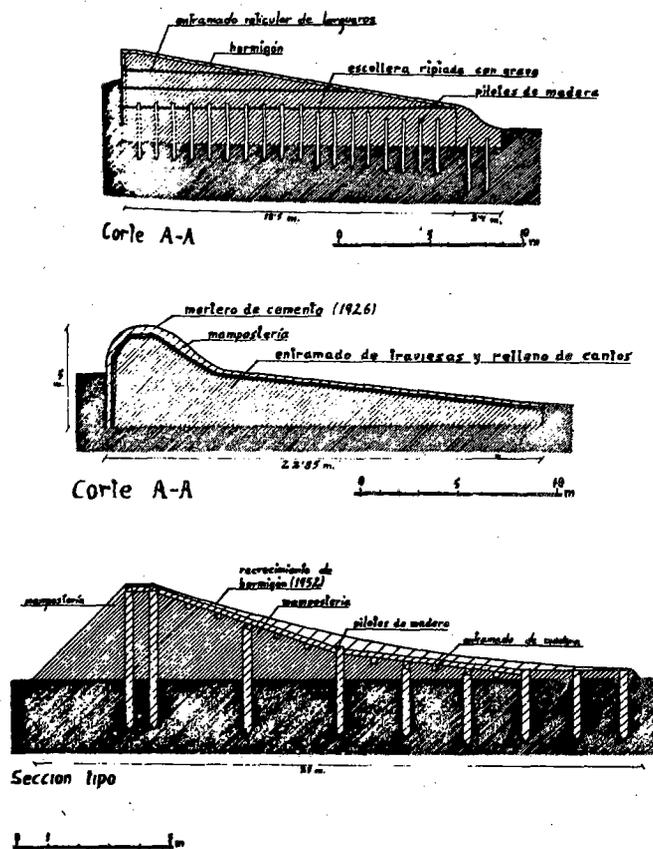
(a) Sección transversal de la presa de El Embocador (1530-34).
